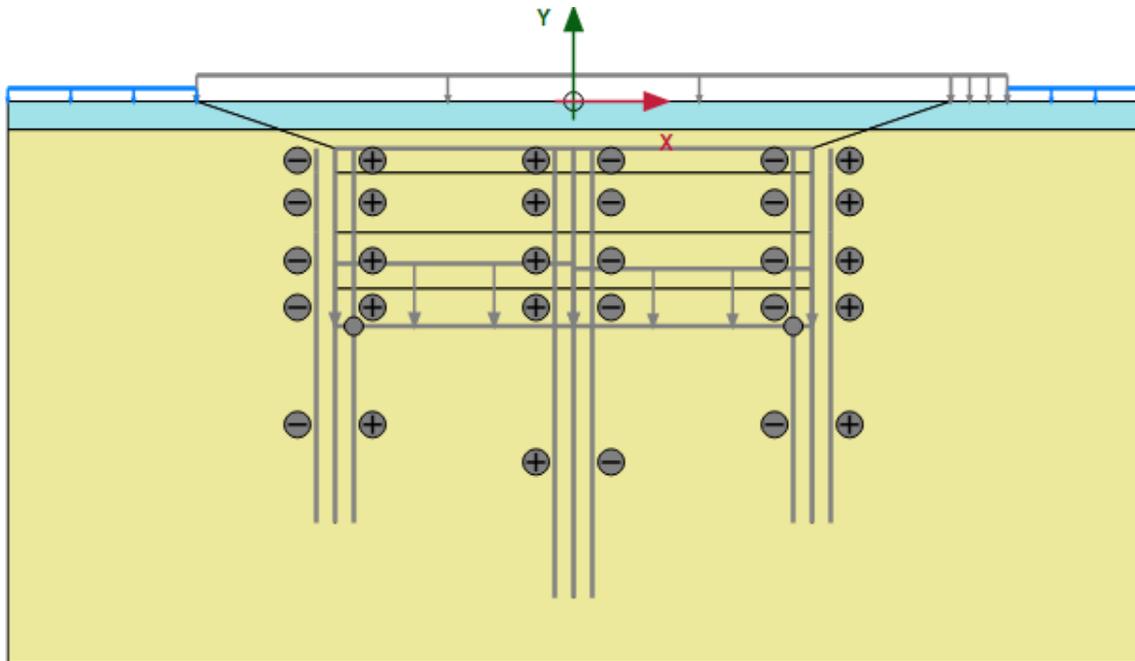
Fase 1: applicazione del carico di cantiere di 10 kPa
